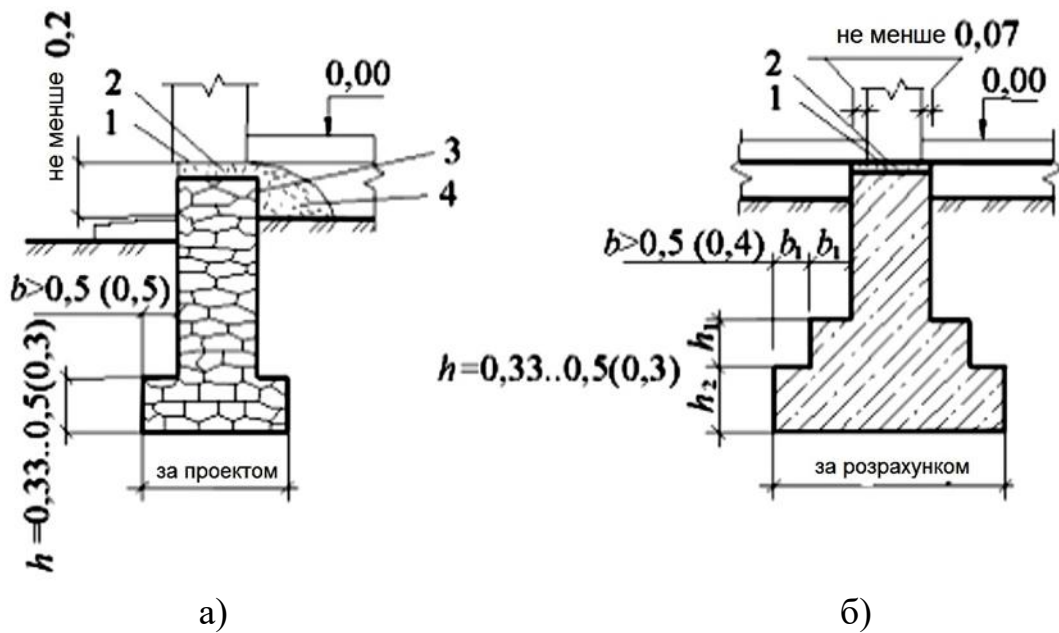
Бутові і бутобетонні фундаменти з уступами: а – під зовнішню стіну; б – під внутрішню стіну; 1 – два шари гідроізоляції на бітумній мастиці; 2 – цементна стяжка; 3 – обмазка гарячим бітумом; 4 – засипка за технічним розрахунком (в дужках приведені дані для бутобетонних фундаментів)
